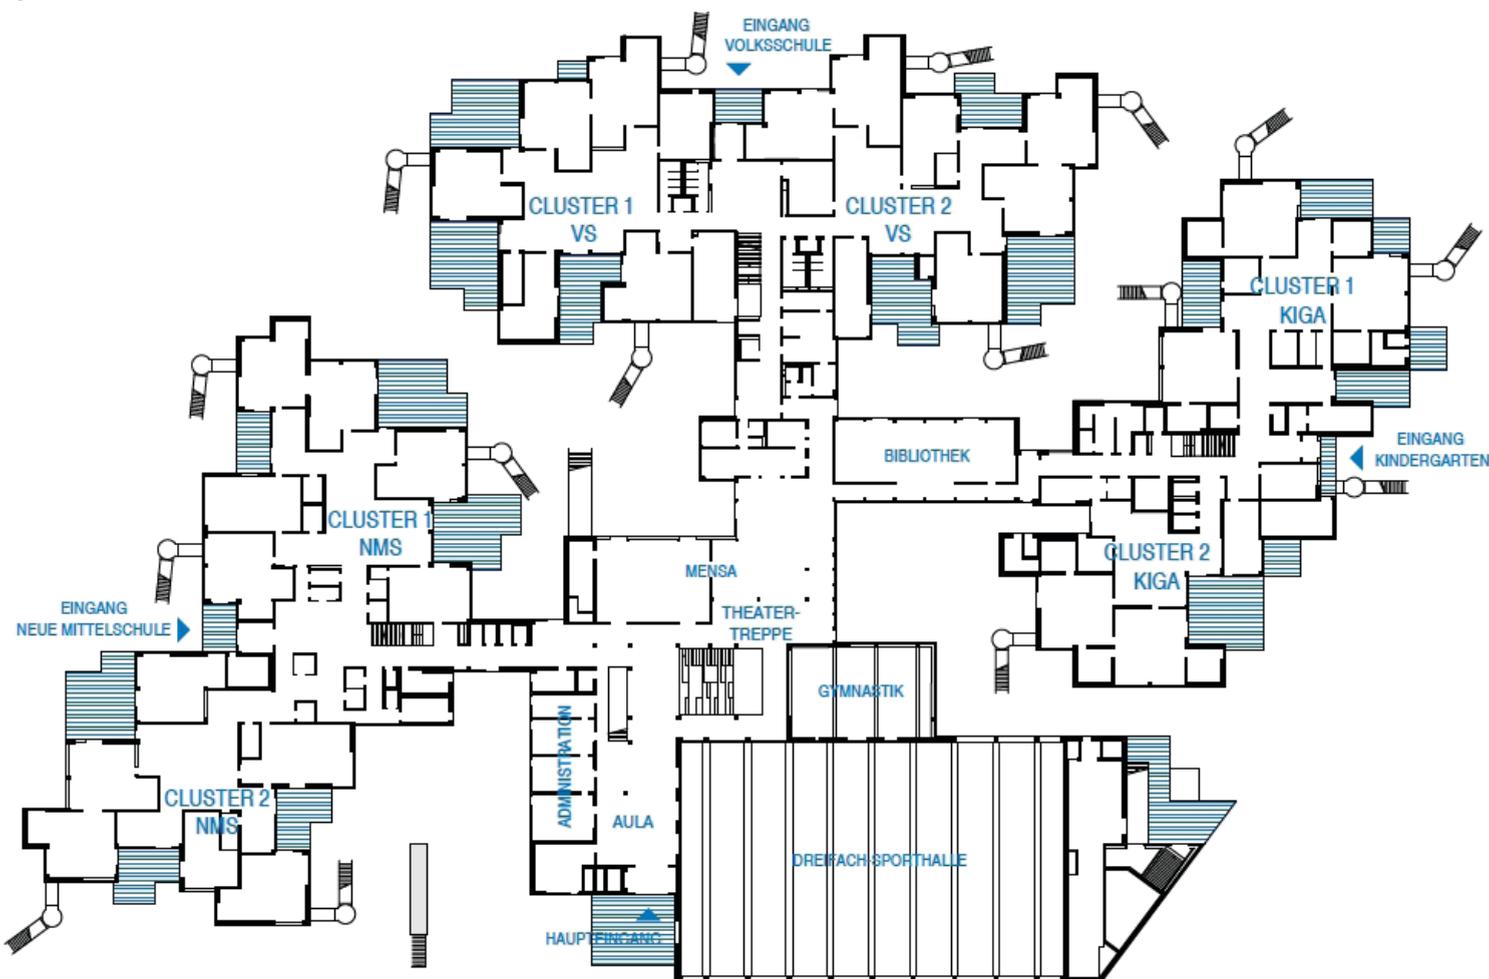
Grundriss Bildungscampus Sonnwendviertel
